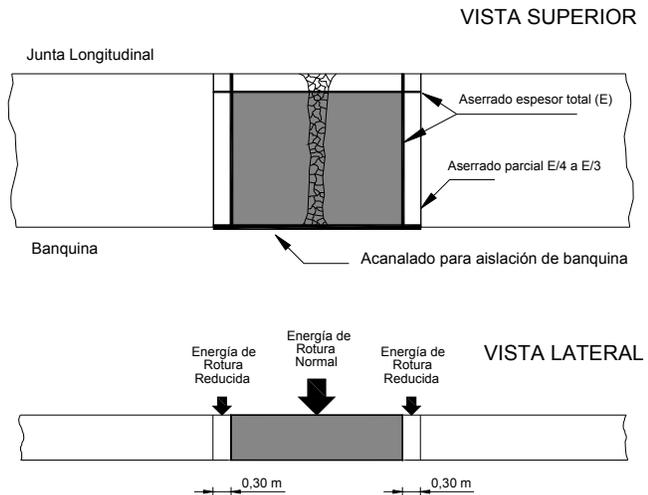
Cortes de protección para evitar roturas inferiores del hormigón sano en la zona perimetral.
